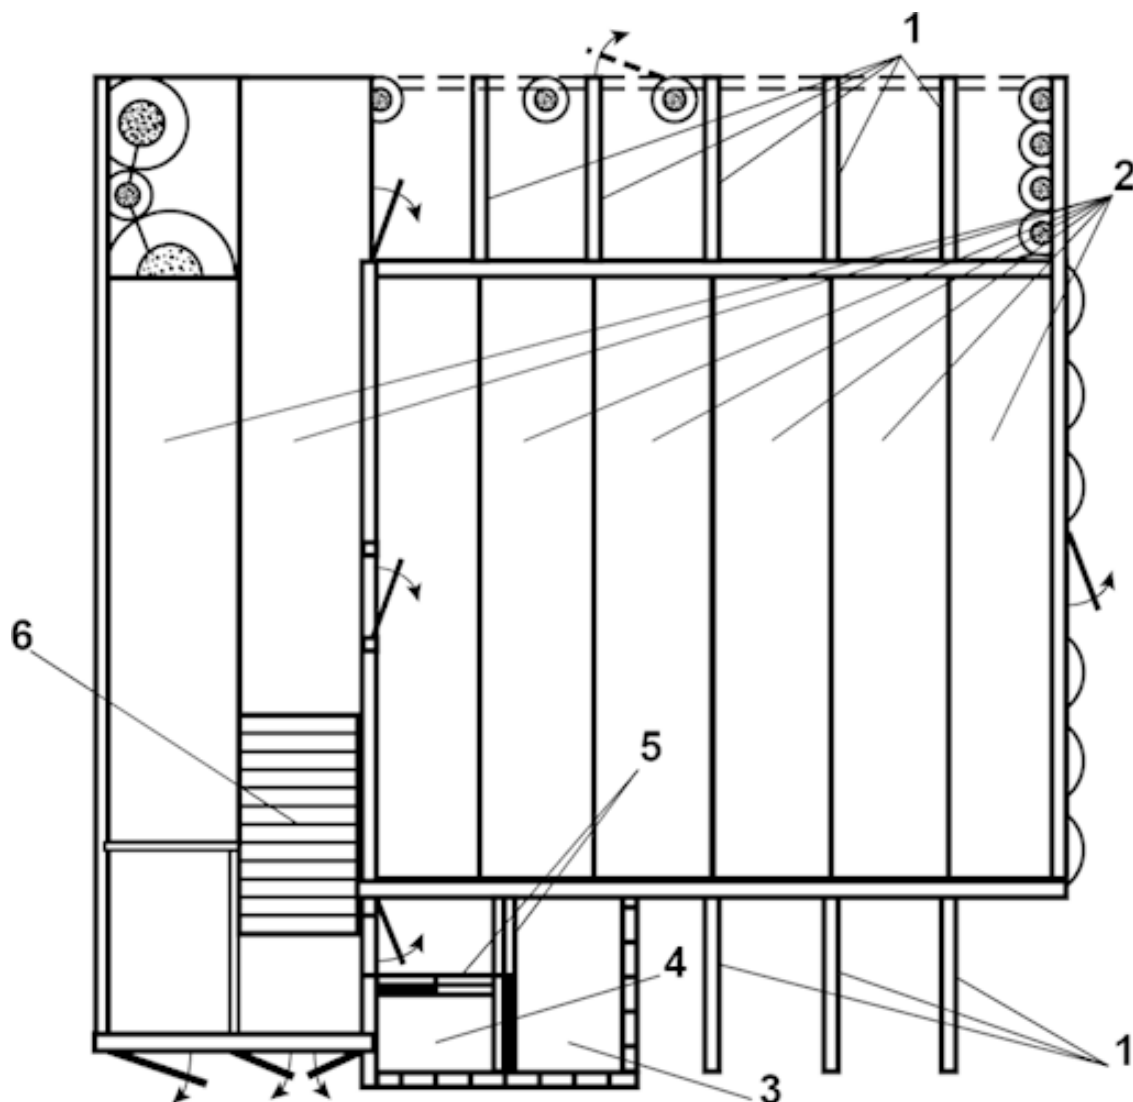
План перекрытия технического этажа: 1 – рельсы; 2 – железобетонные плиты перекрытия; 3 – летний душ; 4 – туалет; 5 – раздвижные двери; 6 – лестничный марш
